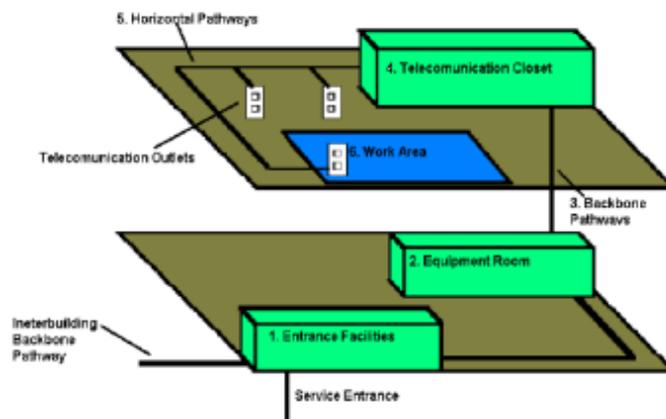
Elementos-Subsistemas del Cableado Estructurado
